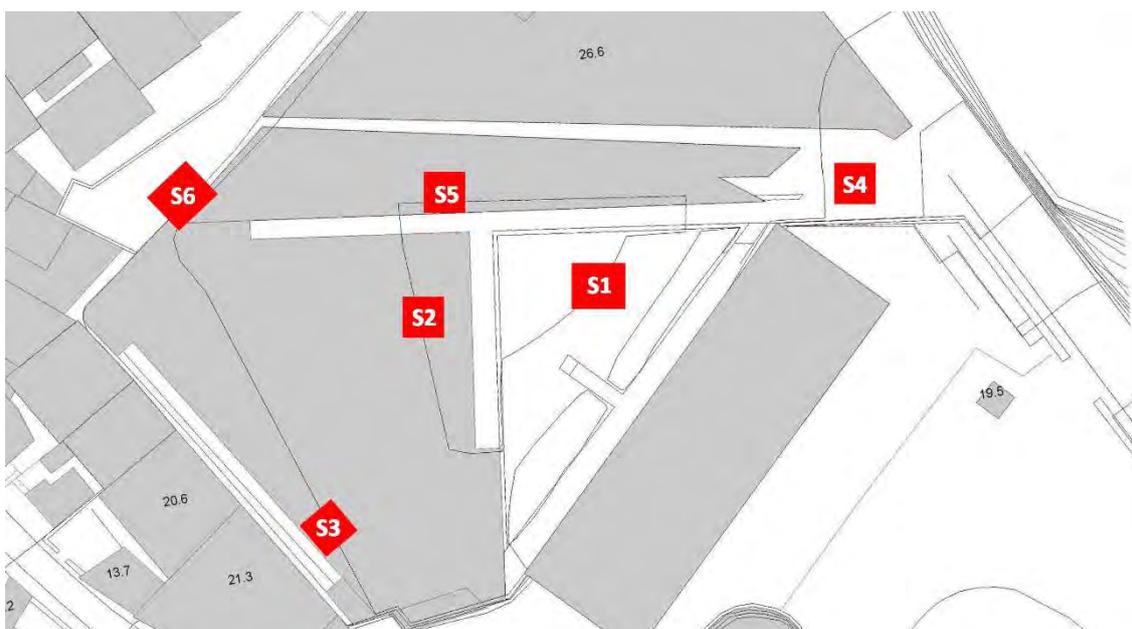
Localização das mesmas sondagens sobre a planta de implantação do monumento.
